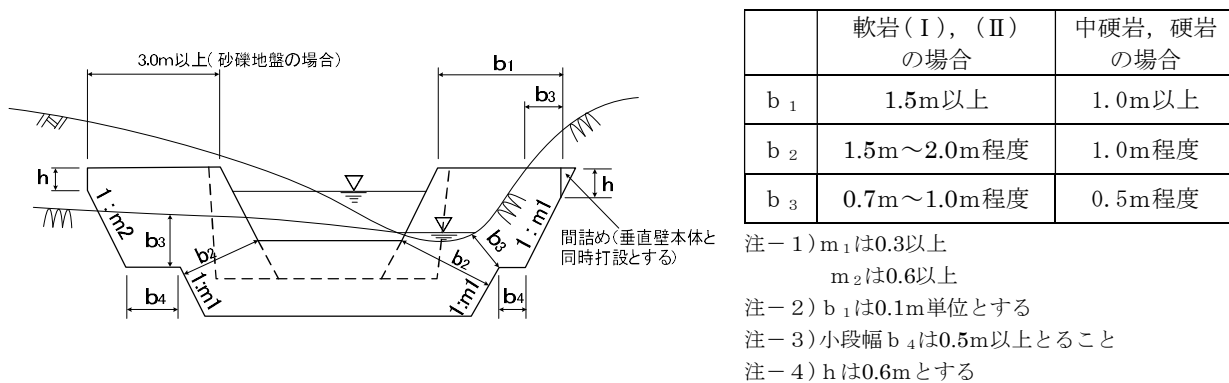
垂直壁の袖の嵌入方法(岩盤の場合)
